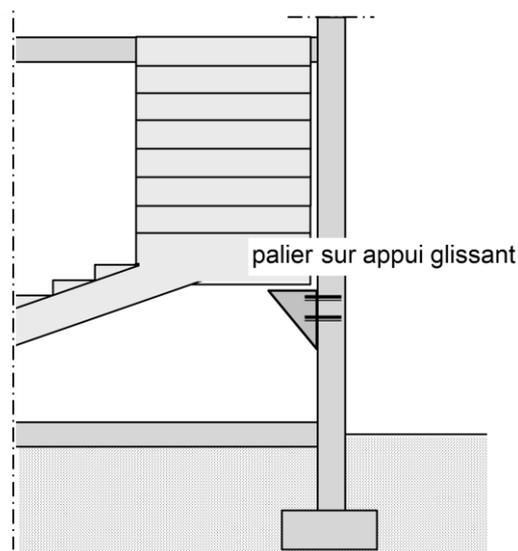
exemple de l'utilisation d'un appui glissant
